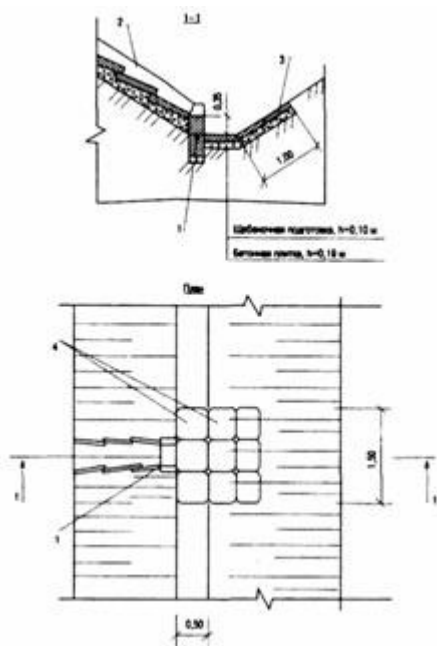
Укрепление нижнего бьефа откосного водосбросного лотка бетонными блоками на автомобильной дороге Яхрома - Красная Горка в Дмитровском районе Московской области: 1 - блок Б-9; 2 - блок Б-6 (Б-7); 3 - блок Б-8; 4 - блок Б-5
